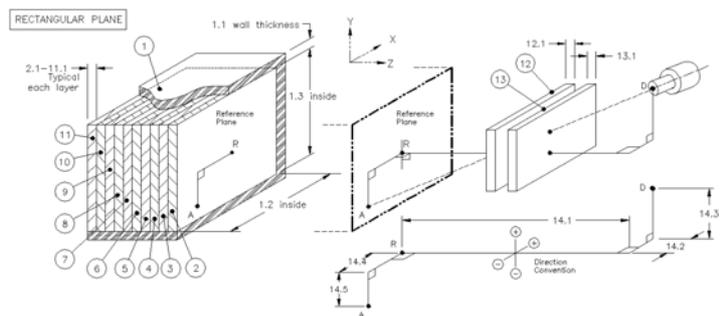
Wandausschnitt mit dazugehörigem Template „Rectangular Plane“
